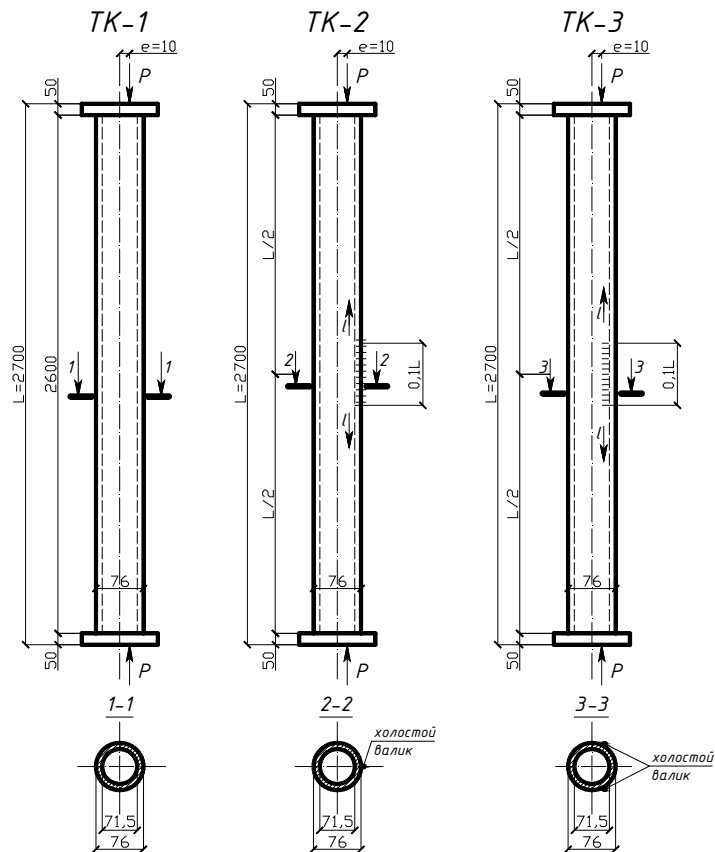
Конструкции образцов серий ТК-1 – ТК-3 с указанием мест приложения силы и наплавки холостых сварных валиков:
